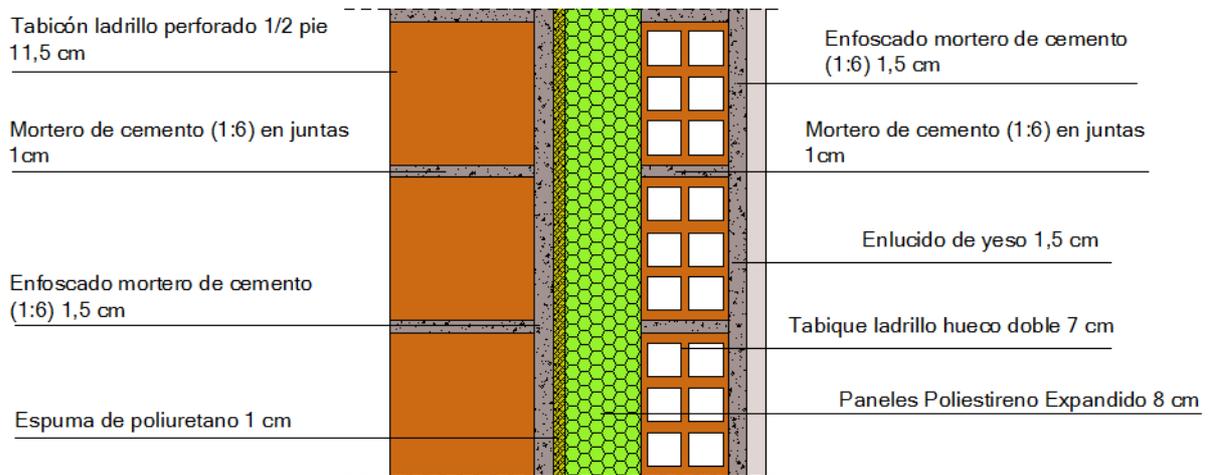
Detalle fachada tipo 1 propuesta.2014. CAD.
